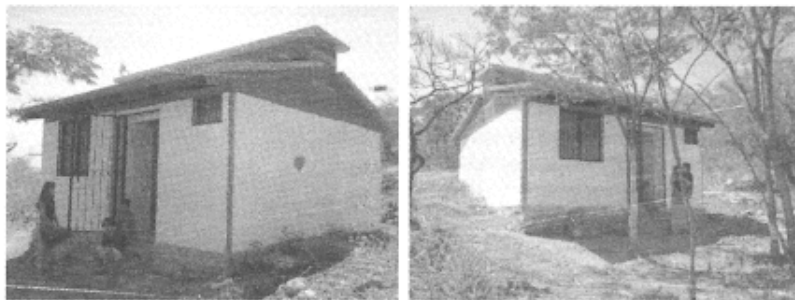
Prototipo construido y ha sido denominado el laboratorio de Arquitectura Bioclimática.
